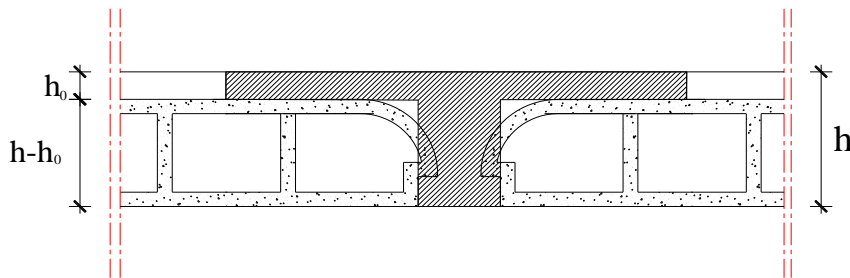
Coupe transversale d'un plancher à corps creux
